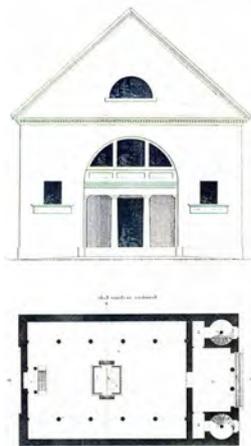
Synagoge, Eichstetten, 1829, Westfassade und Grundriss
